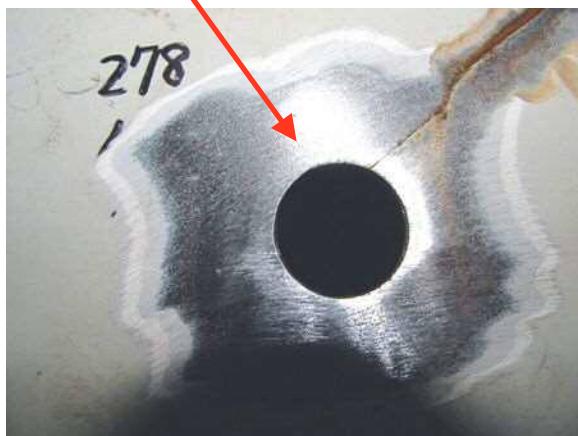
Uリブの突合せ溶接部の当て板補修後
